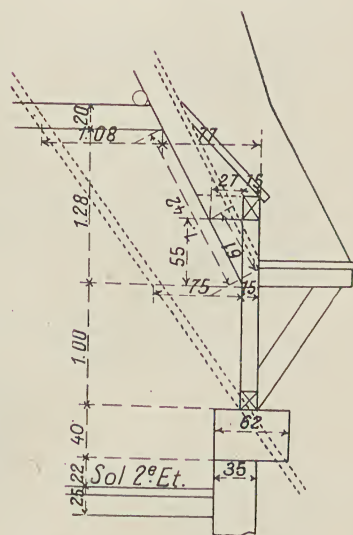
Façade latérale de gauche coupe sur IJ.
